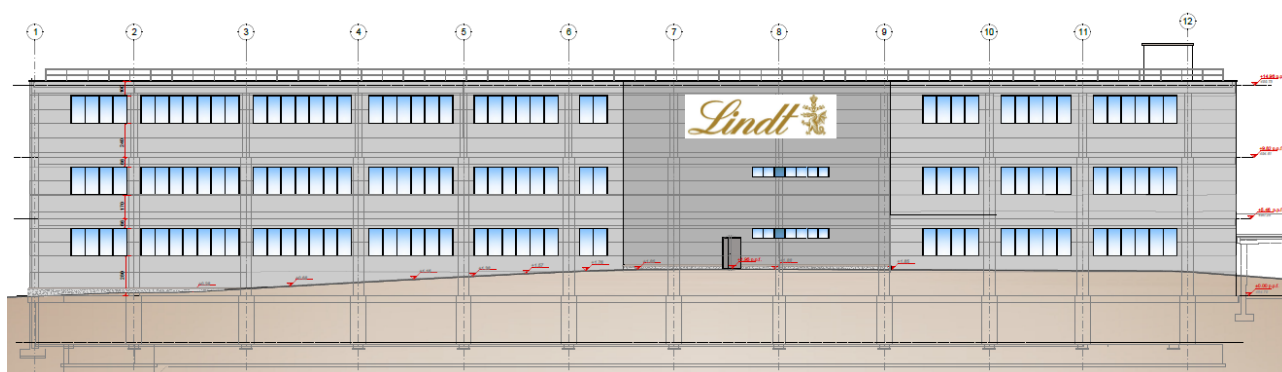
Prospetto Ovest - Fabbricato Ex. Piemonte
